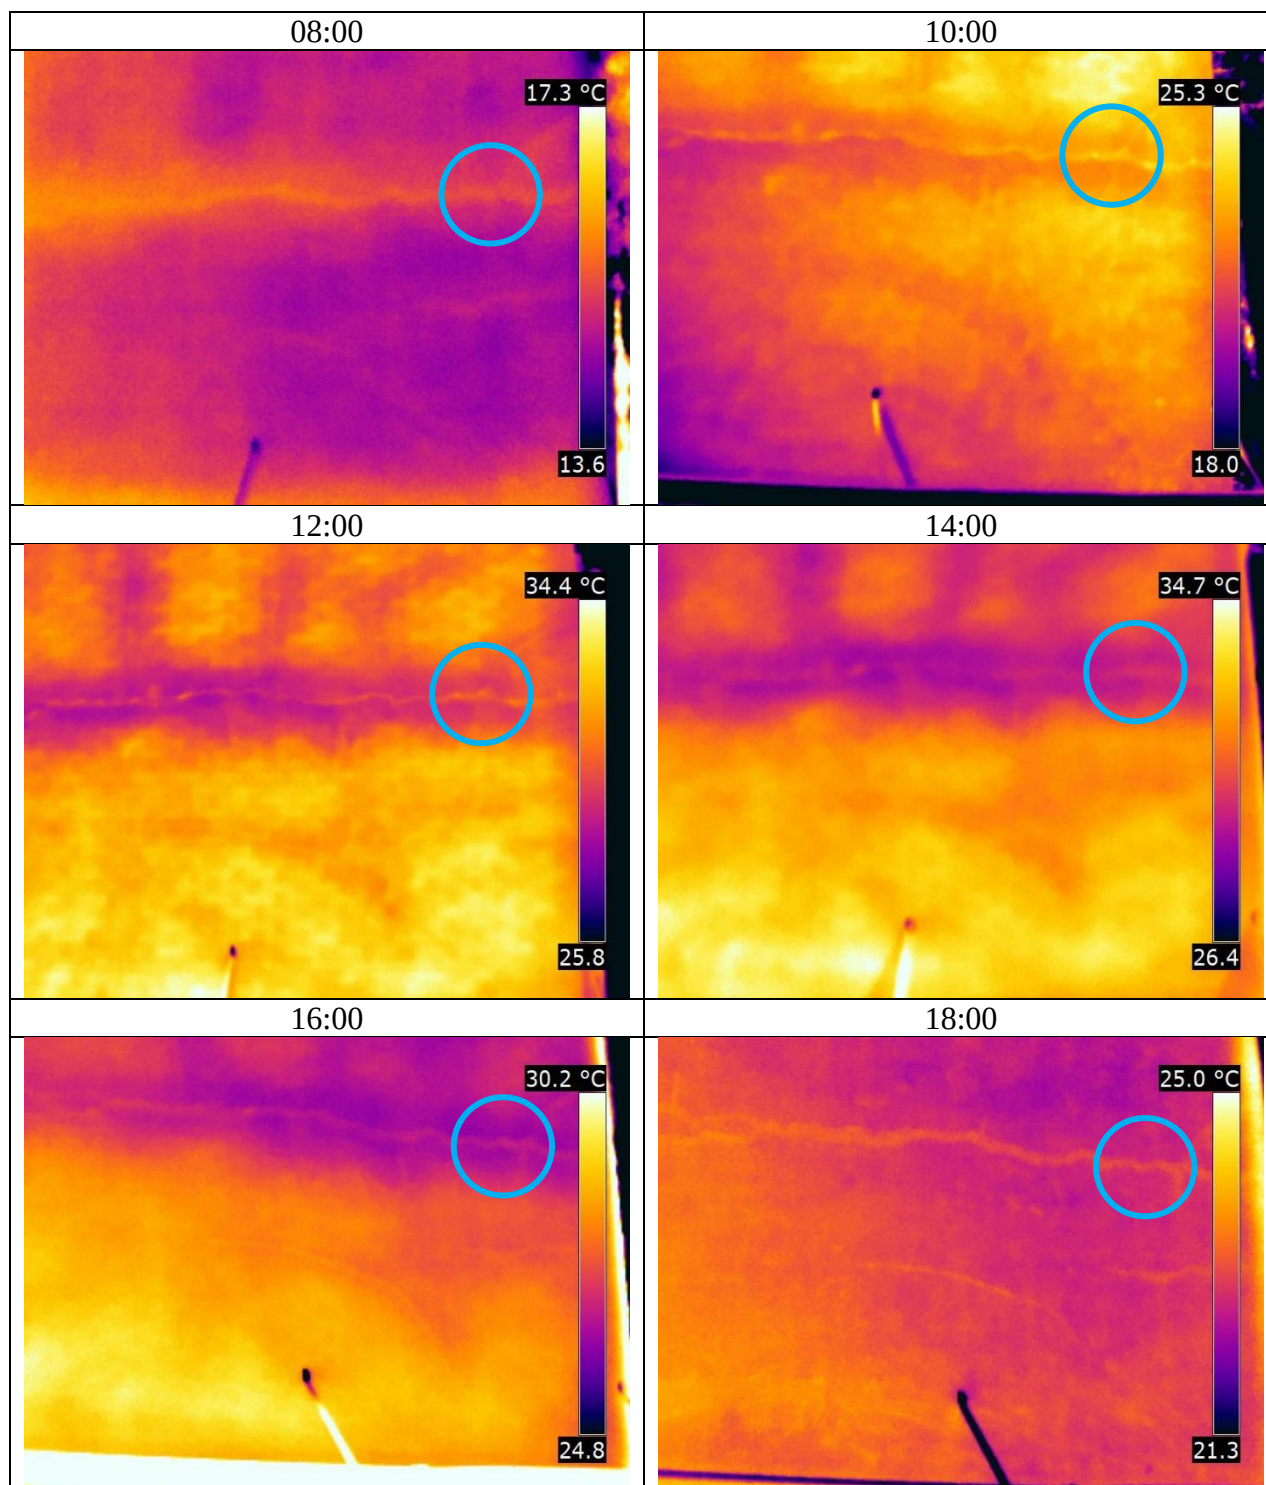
Manifestação patológica na fachada norte do Bloco 46
